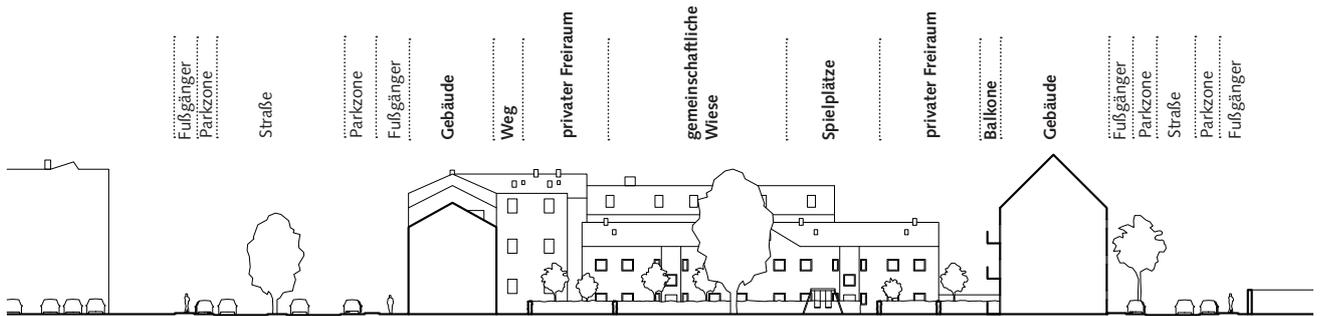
Geländeschnitt mit Blick Richtung Südwesten (Metzgerstraße)
